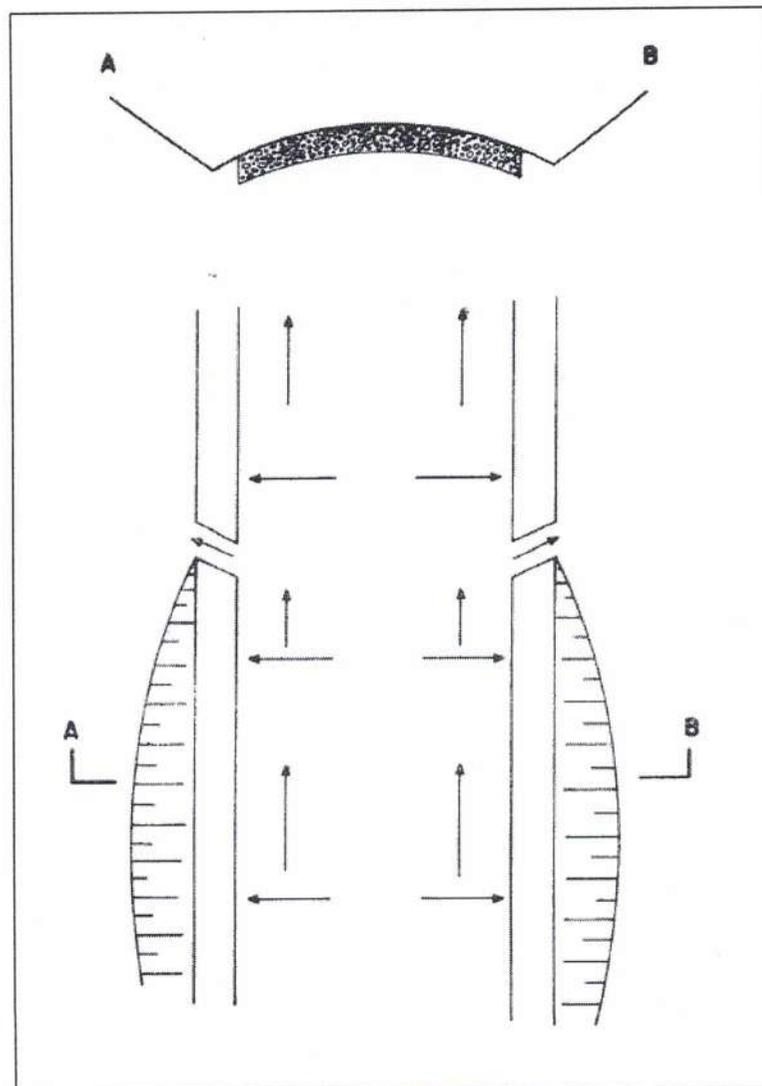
Detalhe esquemático em planta dos dispositivos da via e indicação da declividade
